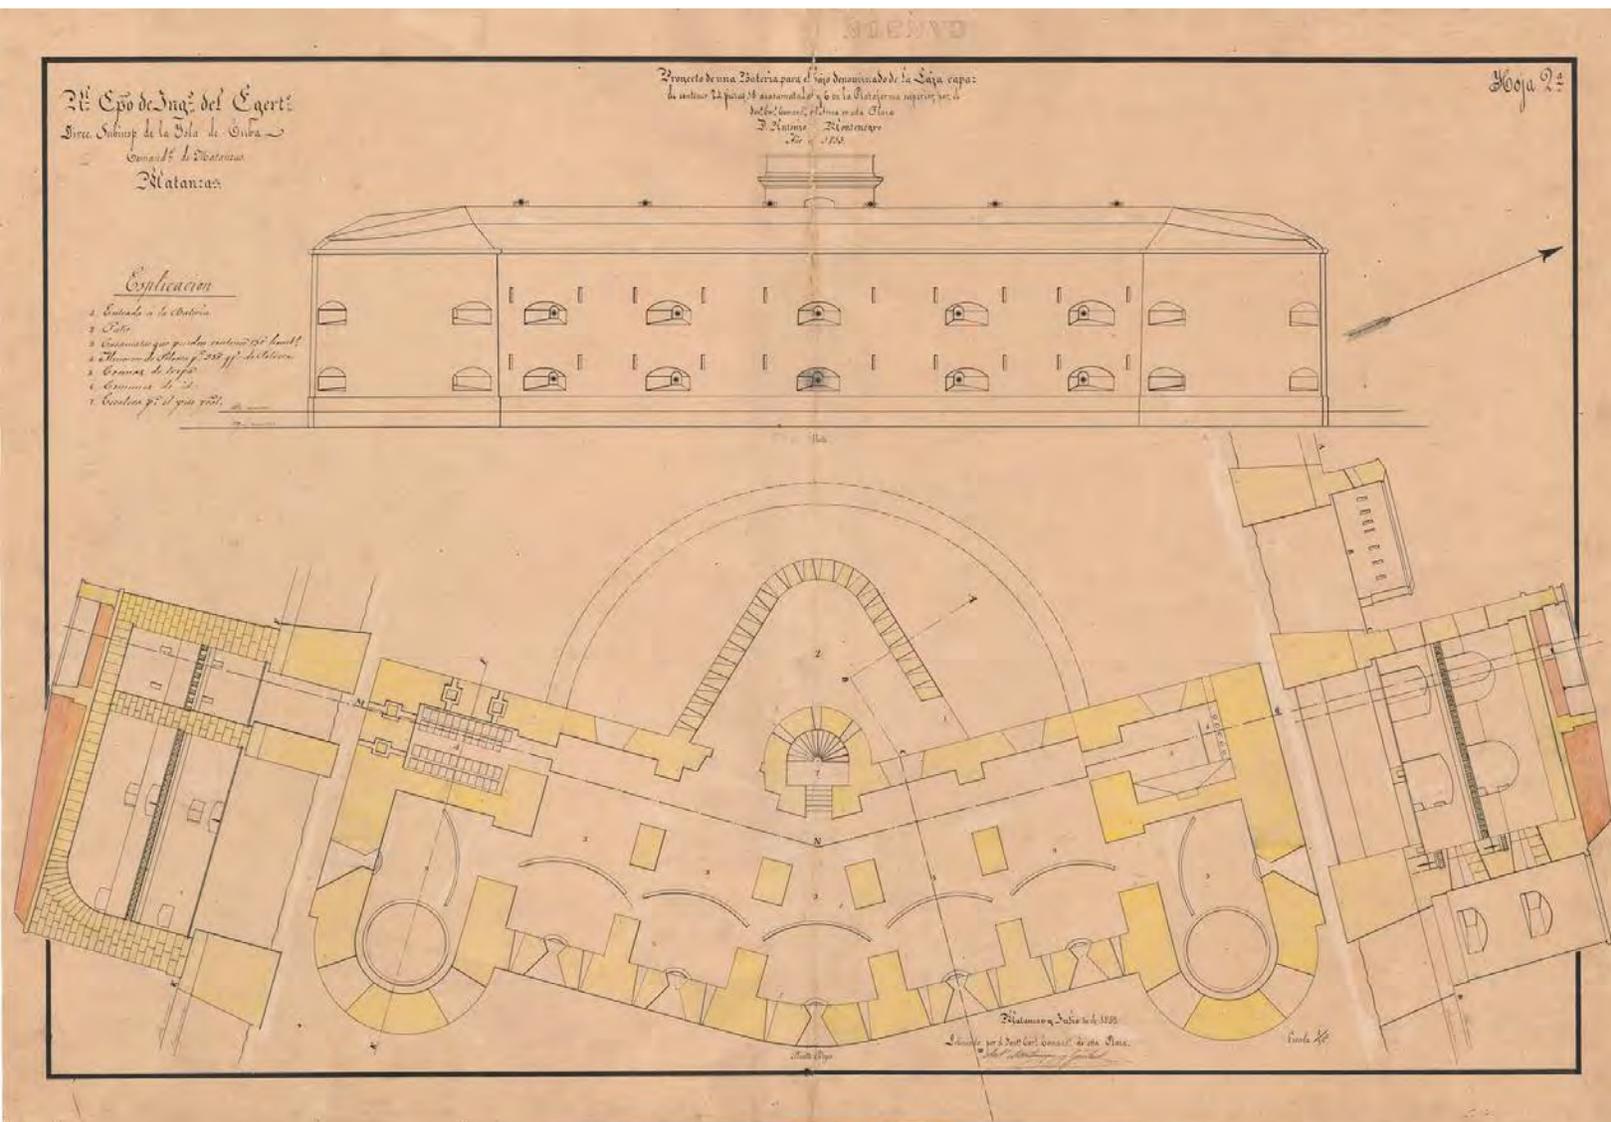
Proyecto de batería para el bajo denominado de La Laja, capaz de contener 24 piezas de 18 acasamatadas y 6 en la plataforma superior (1853). AGMM, CUB-105-18.
